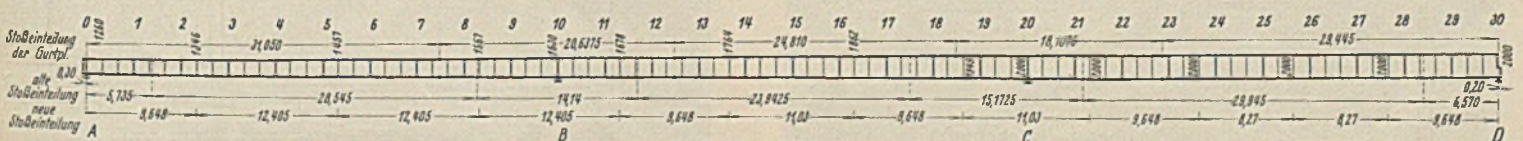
Geschweißter Flutbrückenabschnitt A-D mit Stoßeinteilung der Gurtplatten und der Stehbleche.
